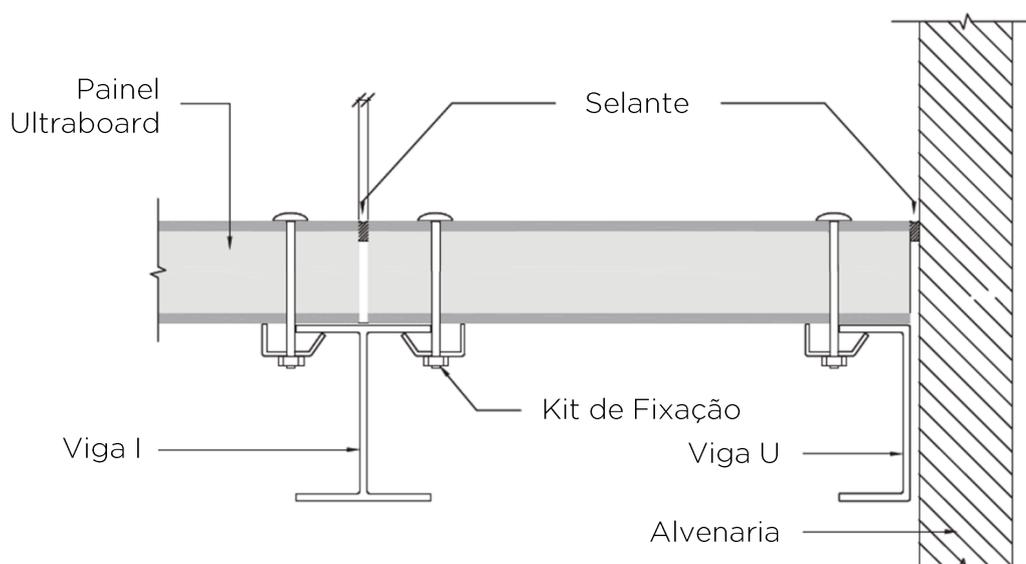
Detalhe de fixação do Painel Ultraboard Brasilit sobre viga de aço pesado.
